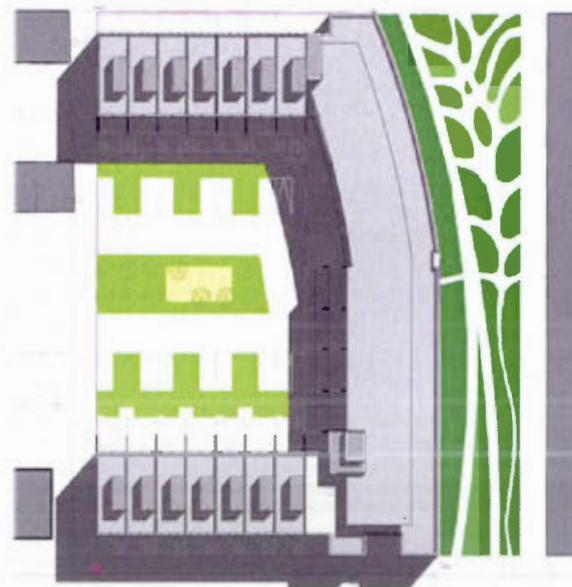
Propositions reçues pour le volet privé de la transformation des terrains de Lavo
